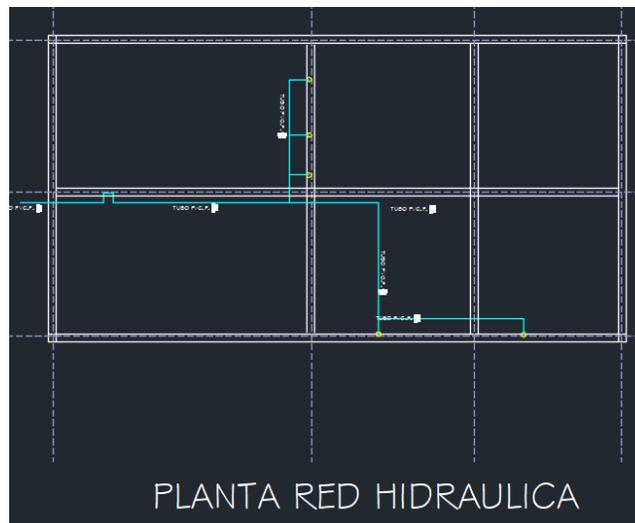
Plano Planta red hidráulica Fuente: Elaboración propia
